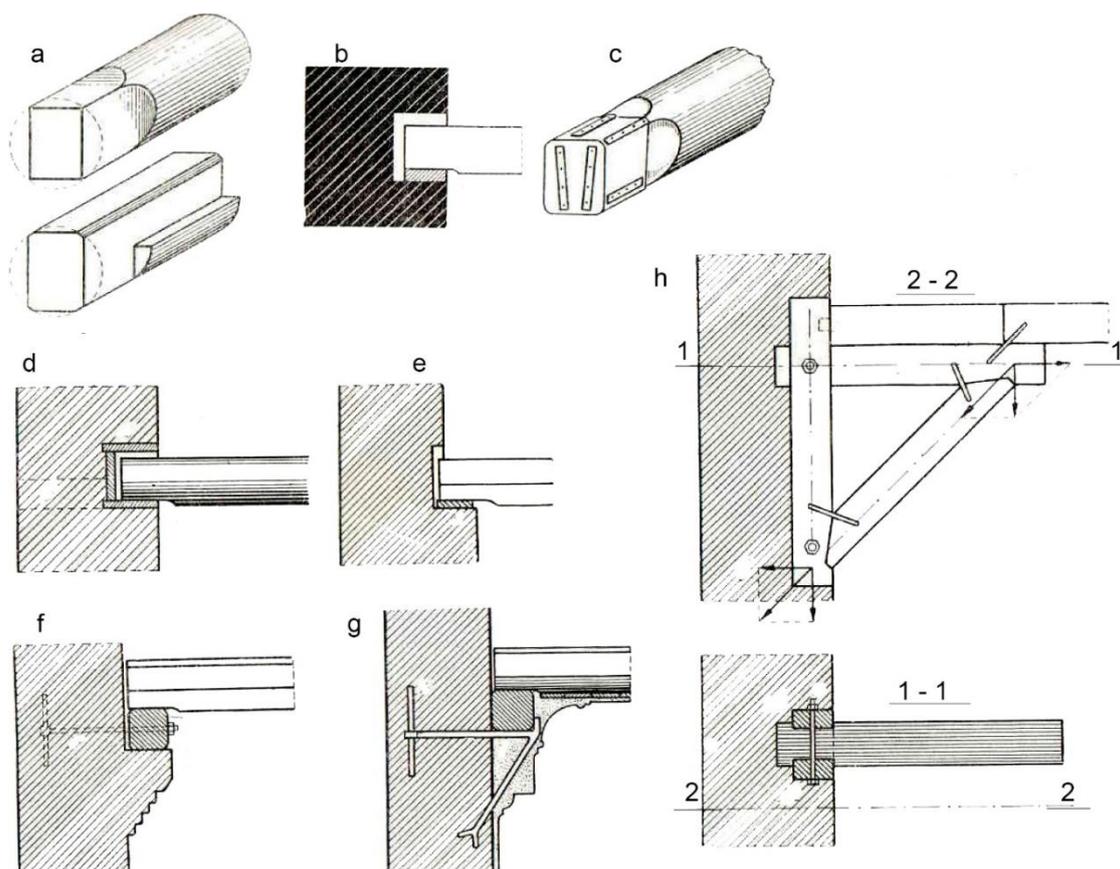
Попираие деревянных балок на кирпичные стены: а – обтесанные концы балок; б – установка балки на осмоленную подкладку; с – обивка конца балки войлоком с креплением дранкой; д – прозор в стене (пунктир) для проветривания заделанного конца балки; е – опираие балки через подкладку на обрез стены; ф – опираие балки на выступ стены через мауэрлат; г – опираие балки на железные кронштейны через мауэрлат; h – опираие укороченных балок на деревянную консоль [33]
